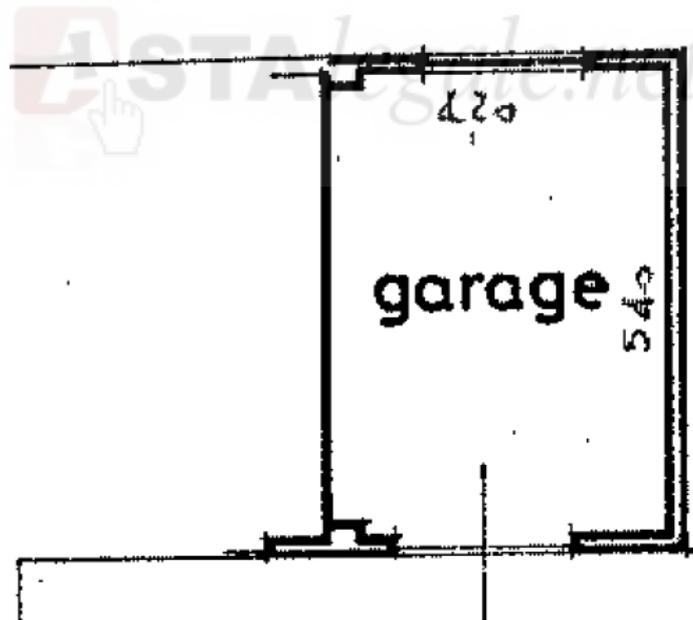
Estratto della planimetria catastale – sub. 3, p.t.
